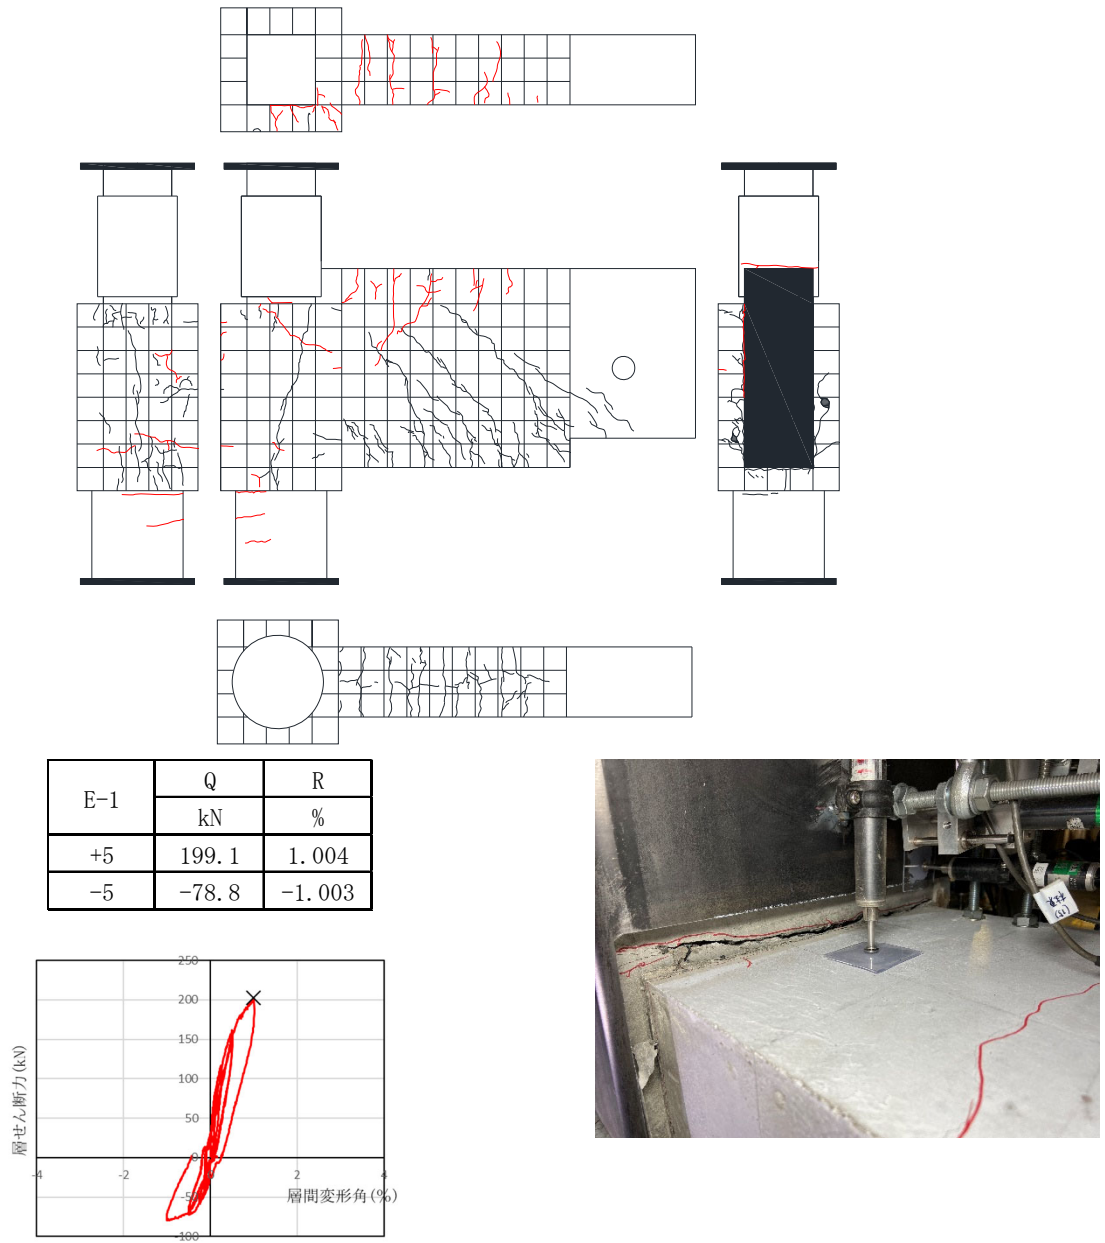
E-1 ひび割れ状況 (2Cycle)
